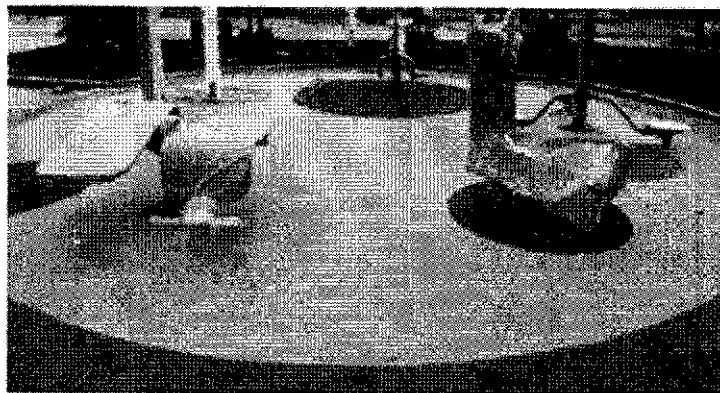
Base en concreto reforzado para maquinas bio saludables
